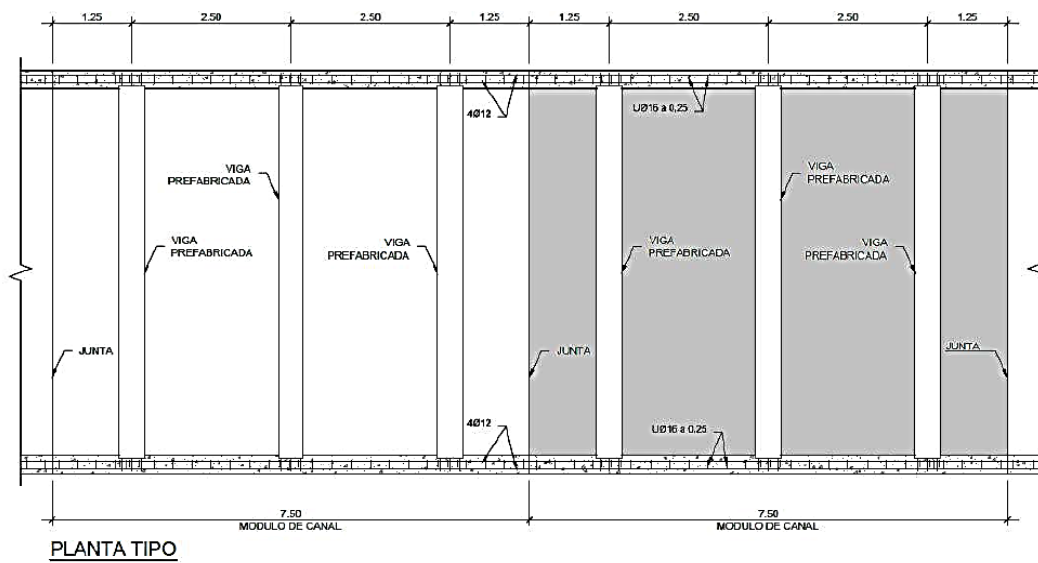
Planta tipo reparación estructural. Canal Calzas Anchas. Utrera (Sevilla). [90]
